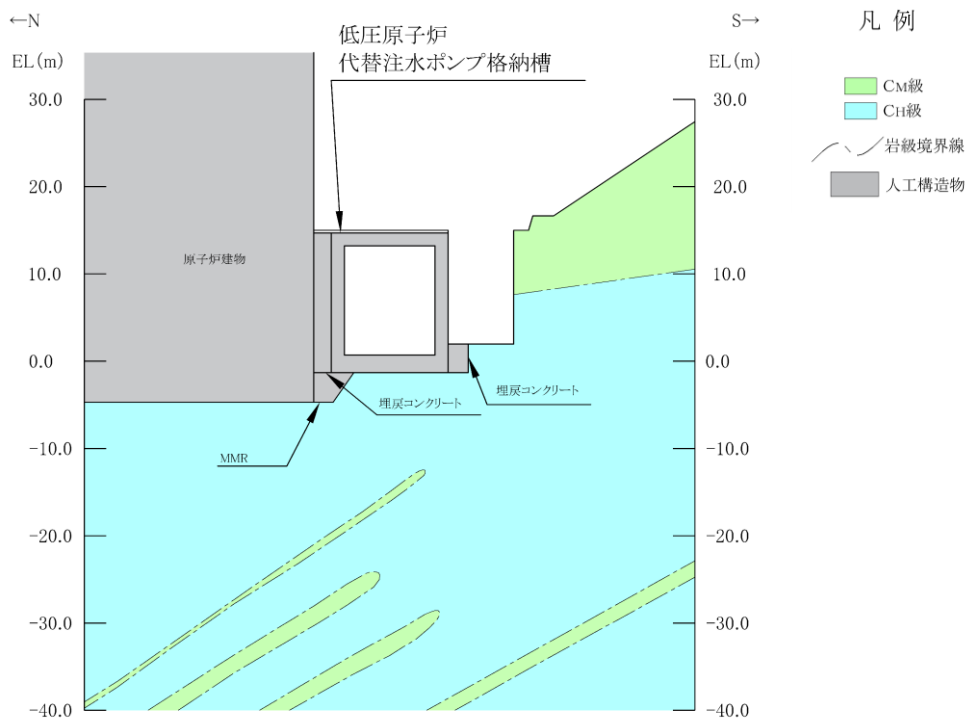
低圧原子炉代替注水ポンプ格納槽 評価対象断面図 (B-B断面位置)
